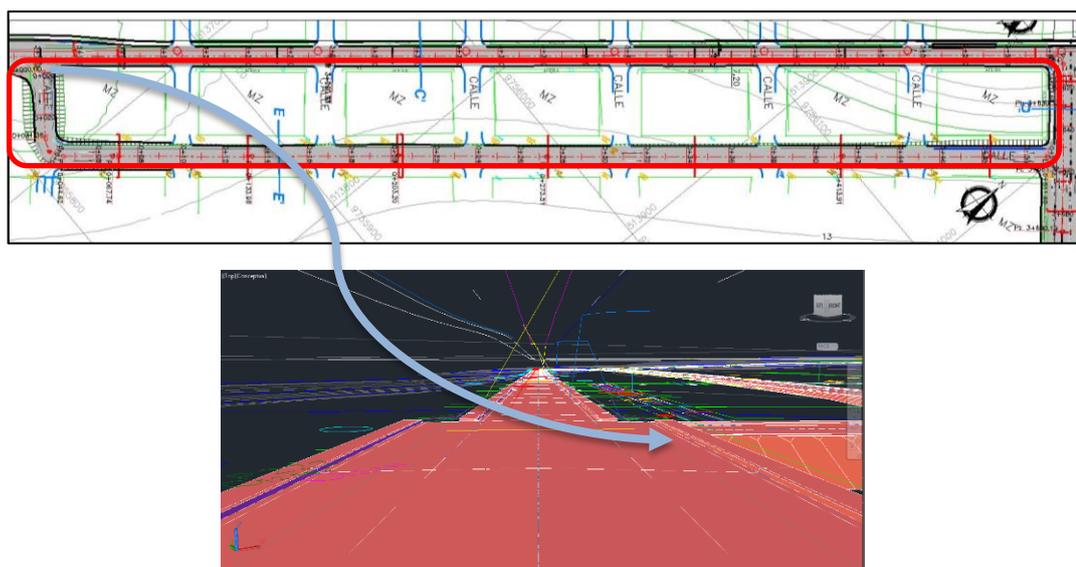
Vista en Planta y Tridimensional del Inicio de la Vía Alternativa.
